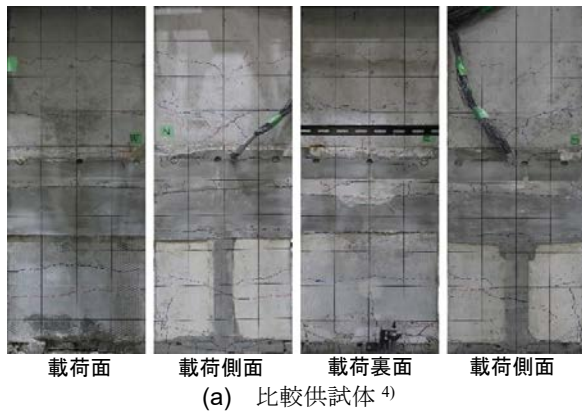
載荷試験2終了時におけるひび割れ状況
